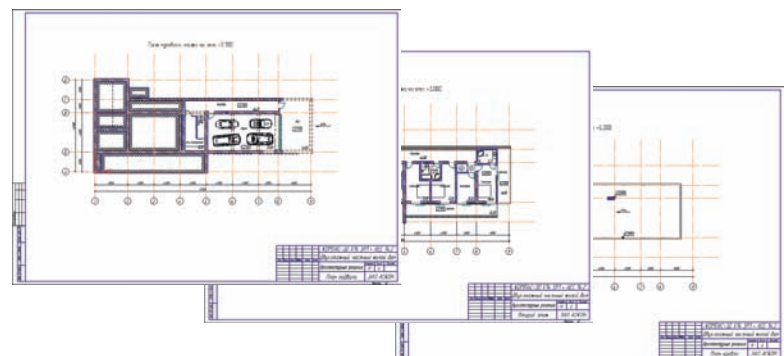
План нулевого (а), второго (б) этажей и кровли (в)
